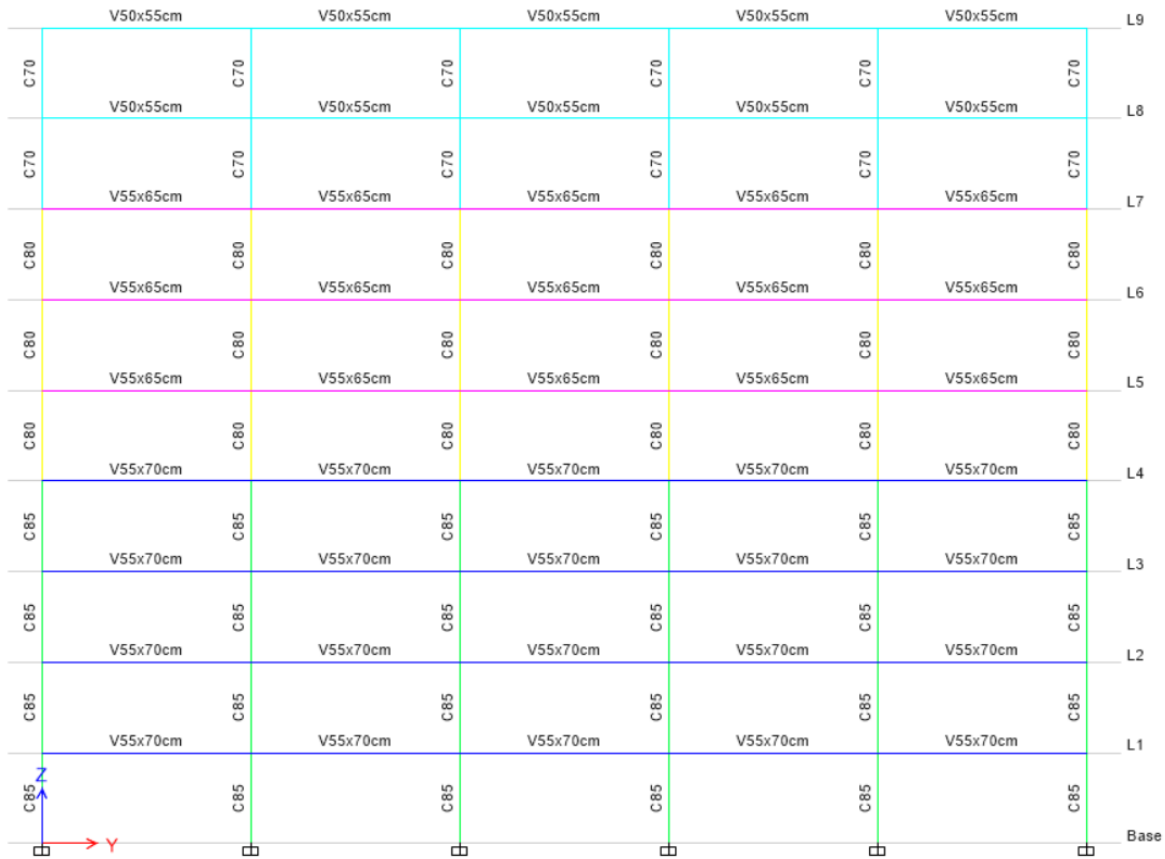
Configuración de un pórtico exterior de las secciones para un edificio de 9 pisos para $\Delta_M = 1.0\%$.
